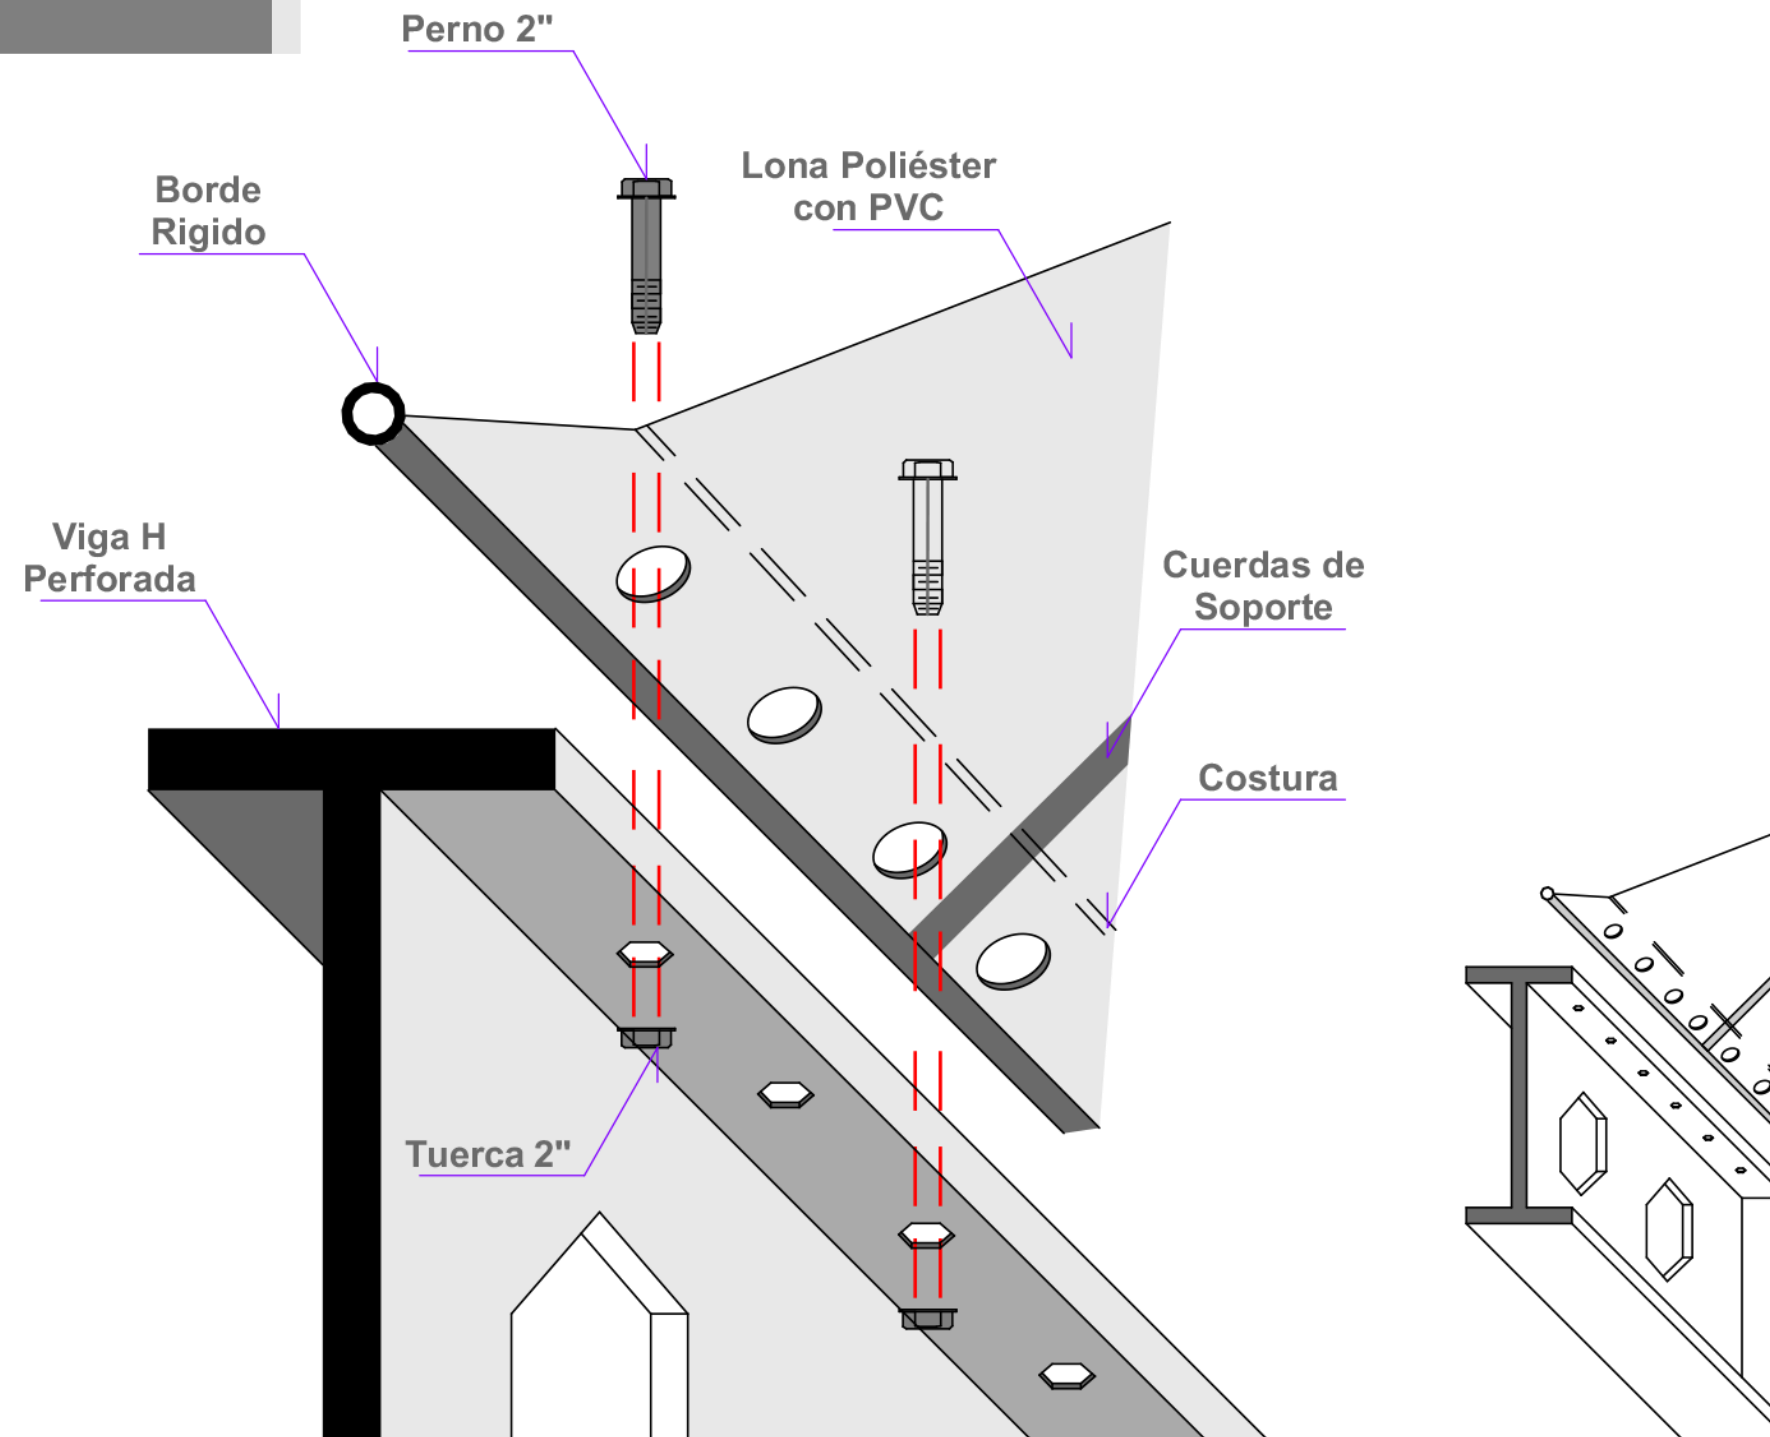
, Detalle Constructivo Conexión Cubierta Textil y Viga H, Propiedad Personal, Tomado 2023
